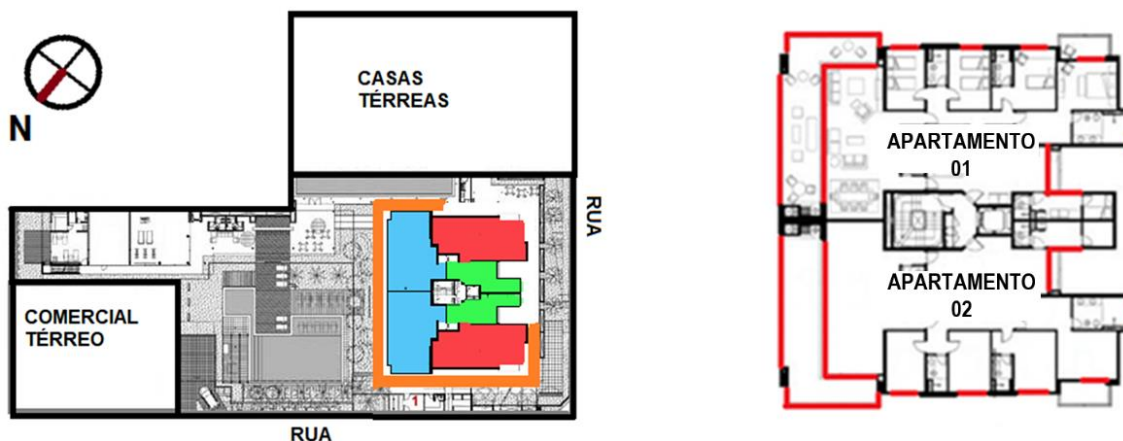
Ed. Breeze, pavimento tipo com duas unidades idênticas rebatidas horizontalmente.
